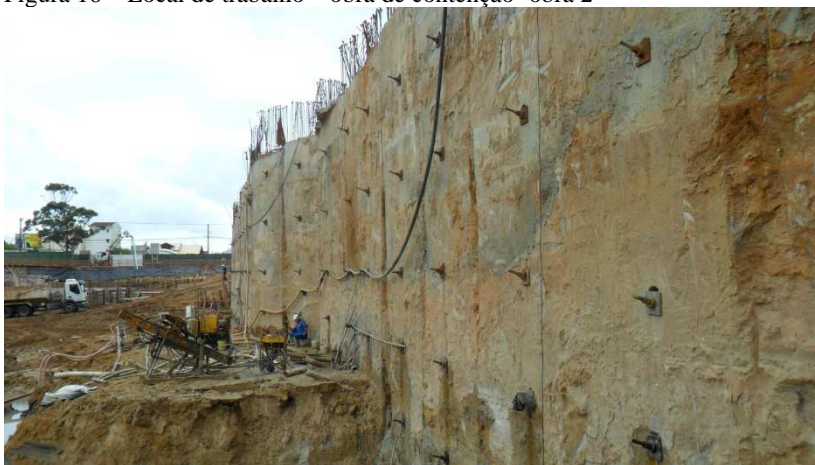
Local de trabalho – Parede atirantada- obra 2
